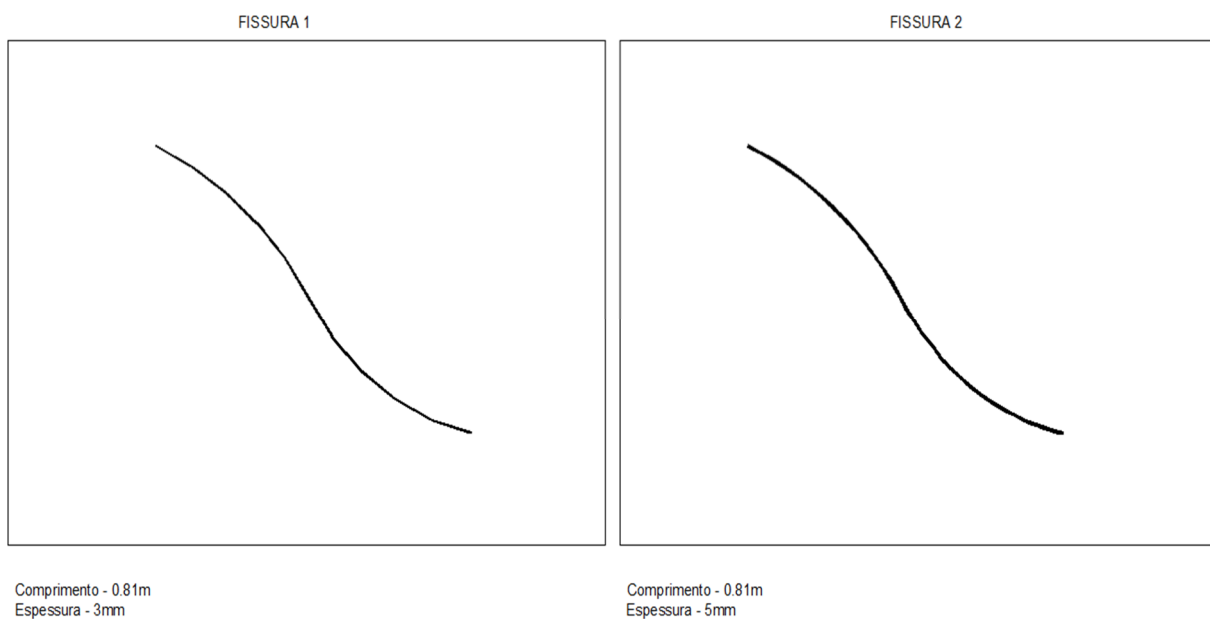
Fissuras 1 e 2 criadas em AutoCAD
